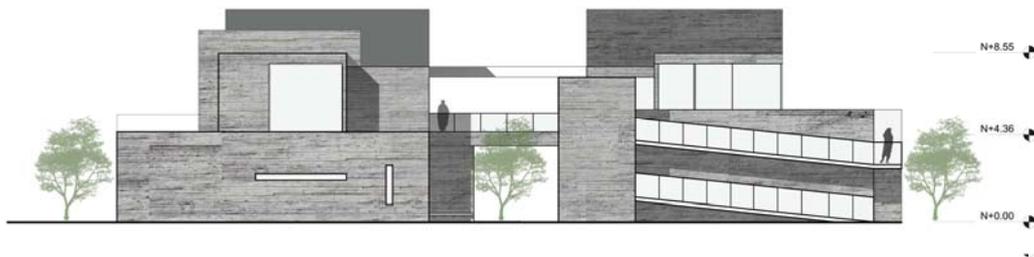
Fachada Oeste. Fuente: Elaborado por el autor
